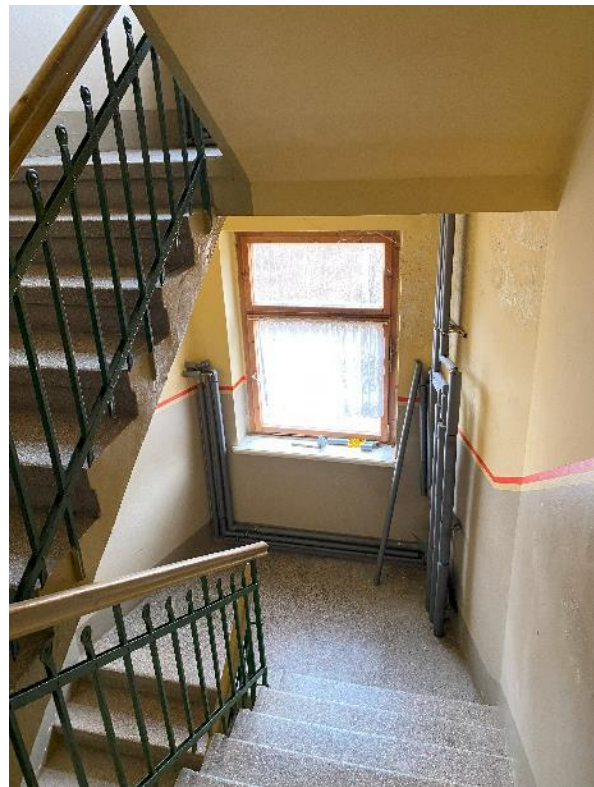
, Treppenpodest mit offener Leitungsdurchführung
